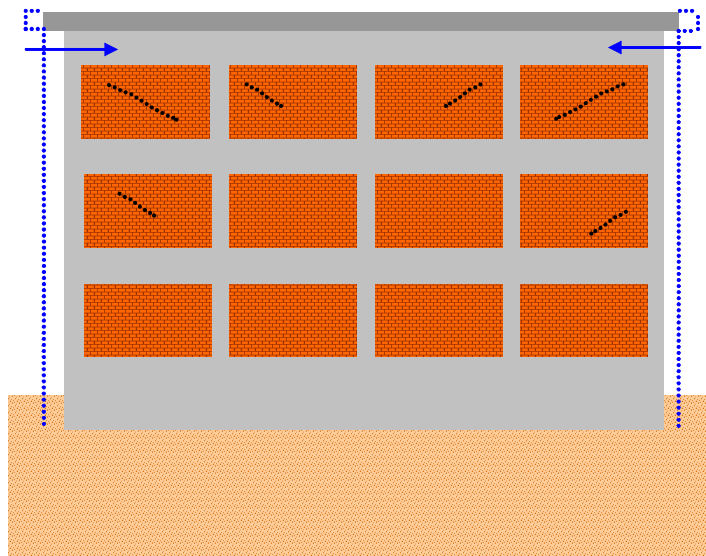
Fissuras devido ao corte em paredes por retracção da estrutura [61]
